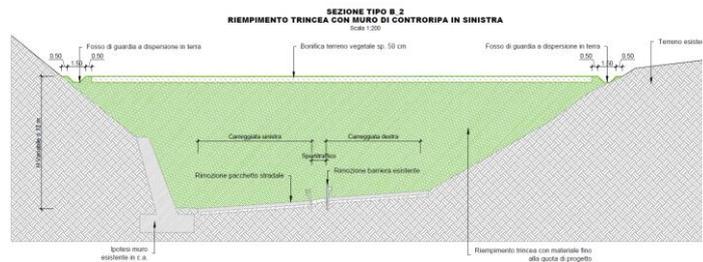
Sezione tipo B_2 riempimento trincea con muro in sinistra
